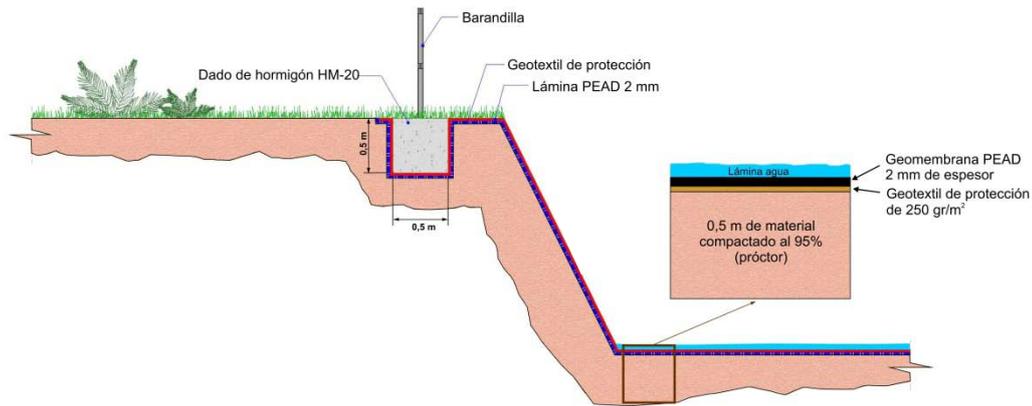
Sección constructiva tipo de la Balsa de Agua Fresca (BAF)
